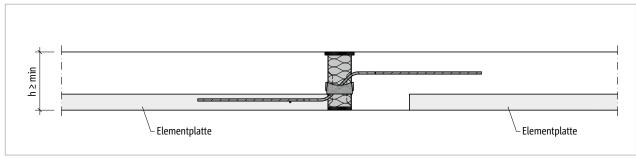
Schöck Isokorb® T Typ QL: Elementdecke mit eingesetzten Schöck Isokorb®
